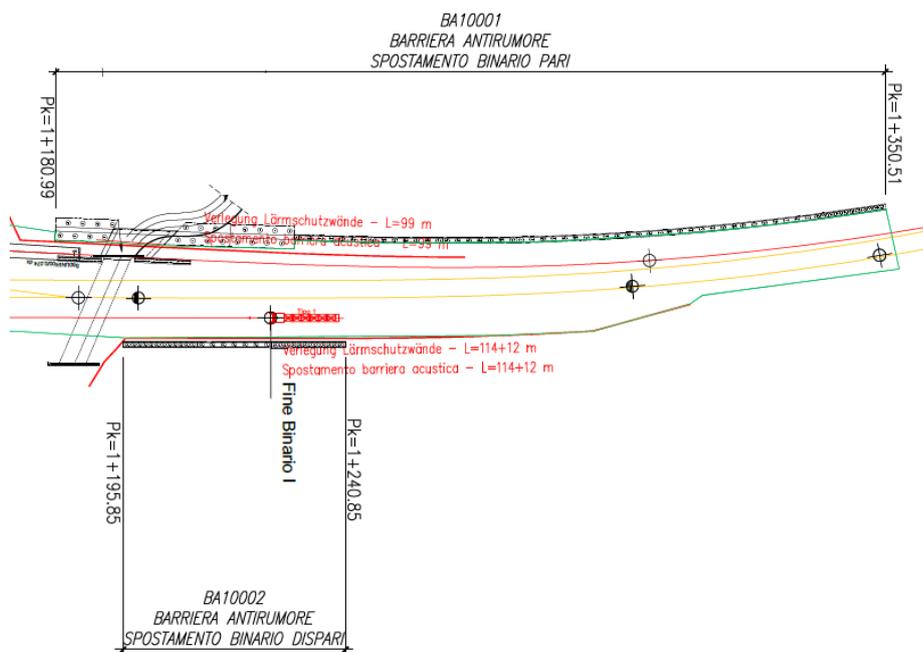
Opere di sostegno - Stralcio planimetrico 2
